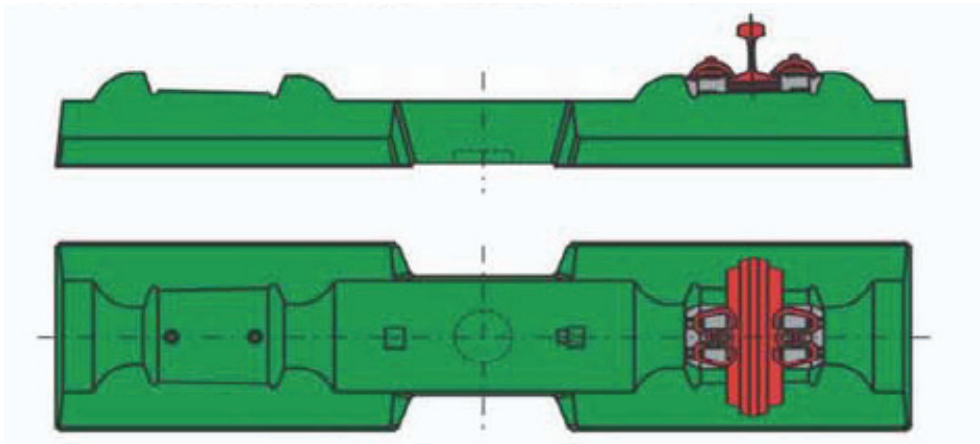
Konstrukcja nawierzchni GETRAC® A1 [14]
